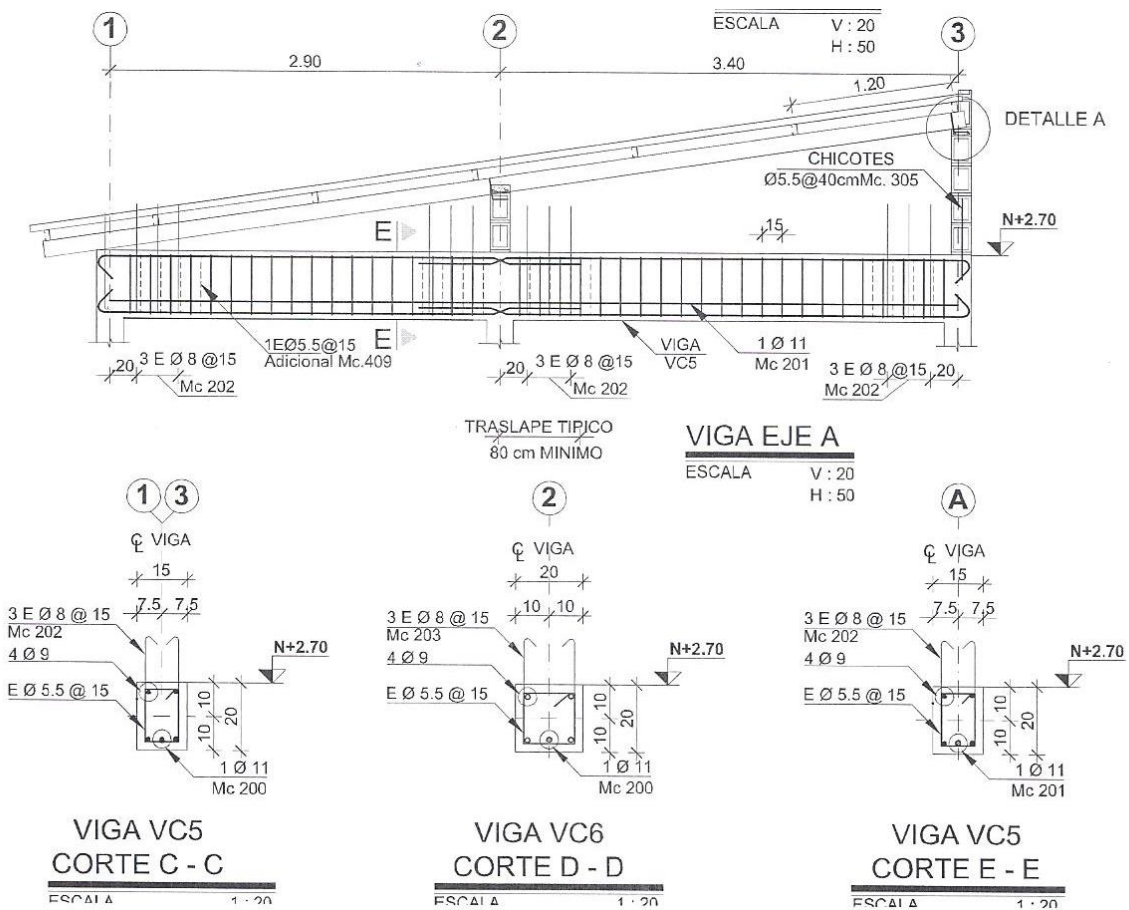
Detalle de la disposición de la viga en el Eje A y sus respectivos traslapes
